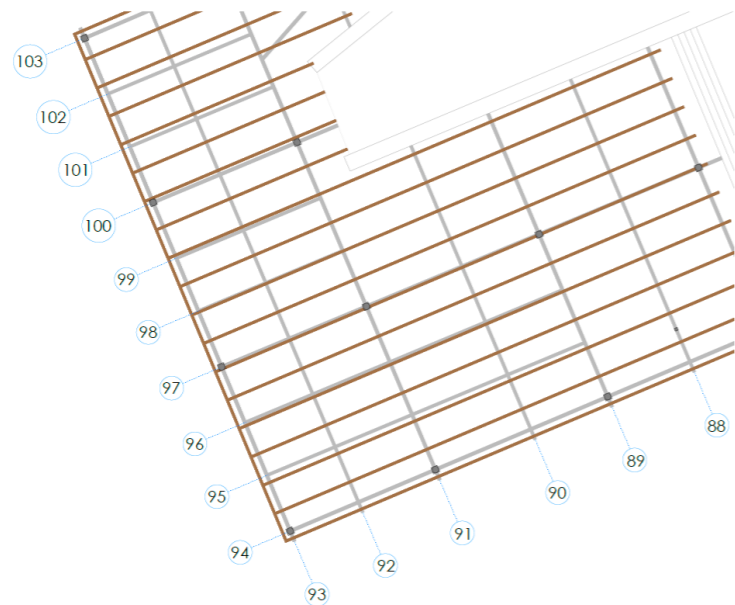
Planta de vigas y pilares objeto de reparación. Replanteo.
